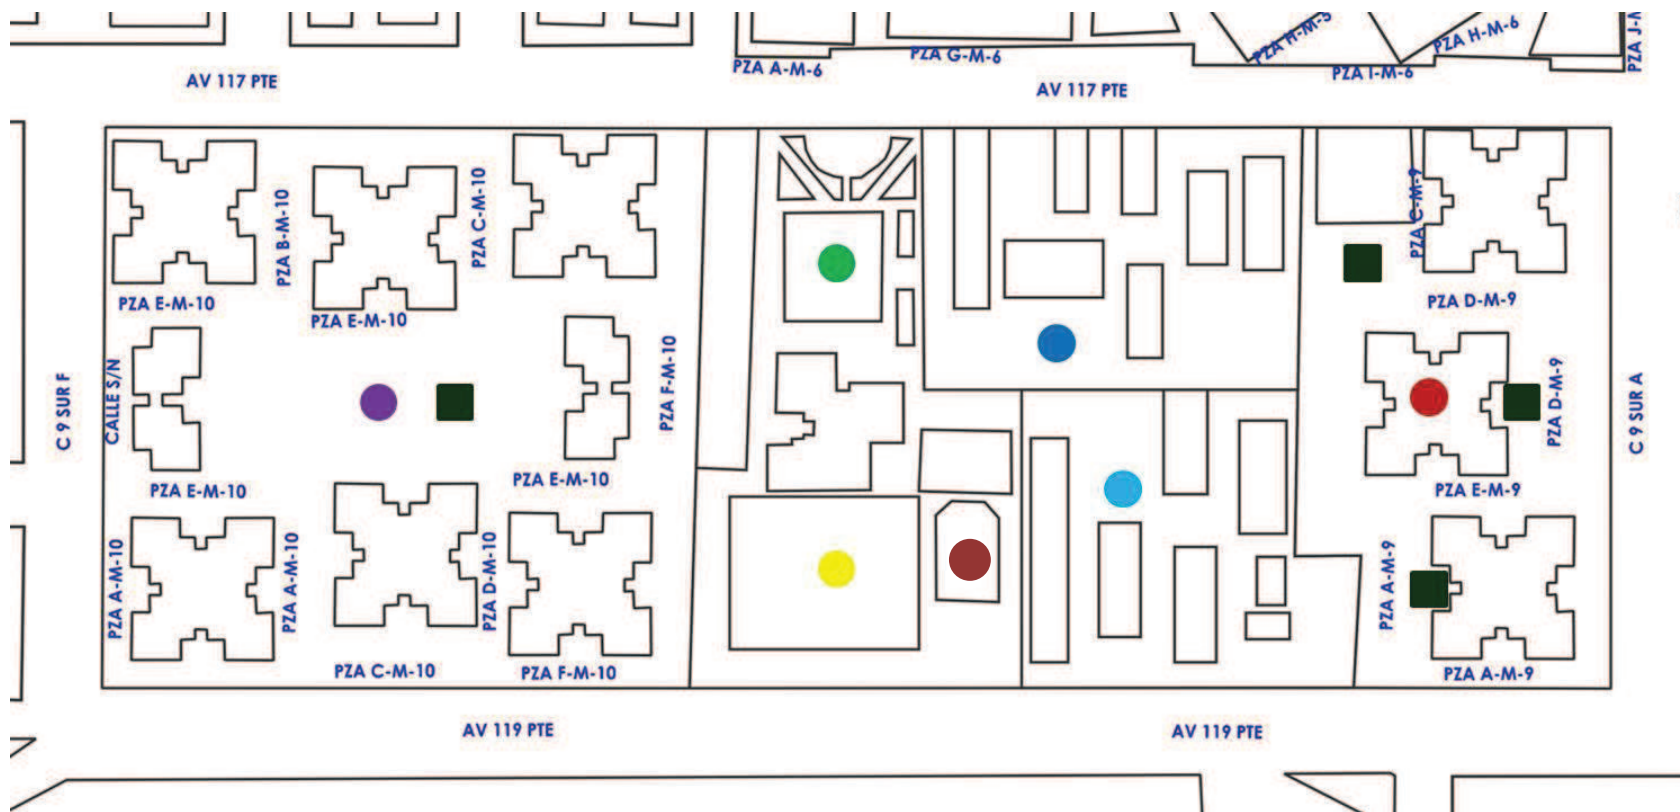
Plano de zonas a intervenir. Por: VRA, 2014
